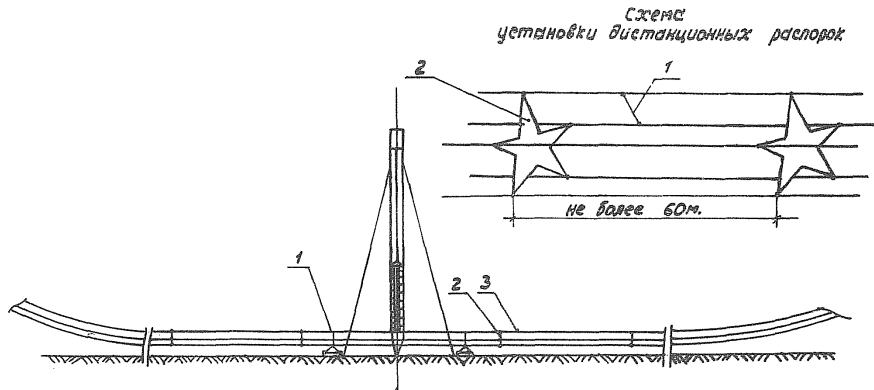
Установка дистанционных распорок при перекладке проводов на земле.
